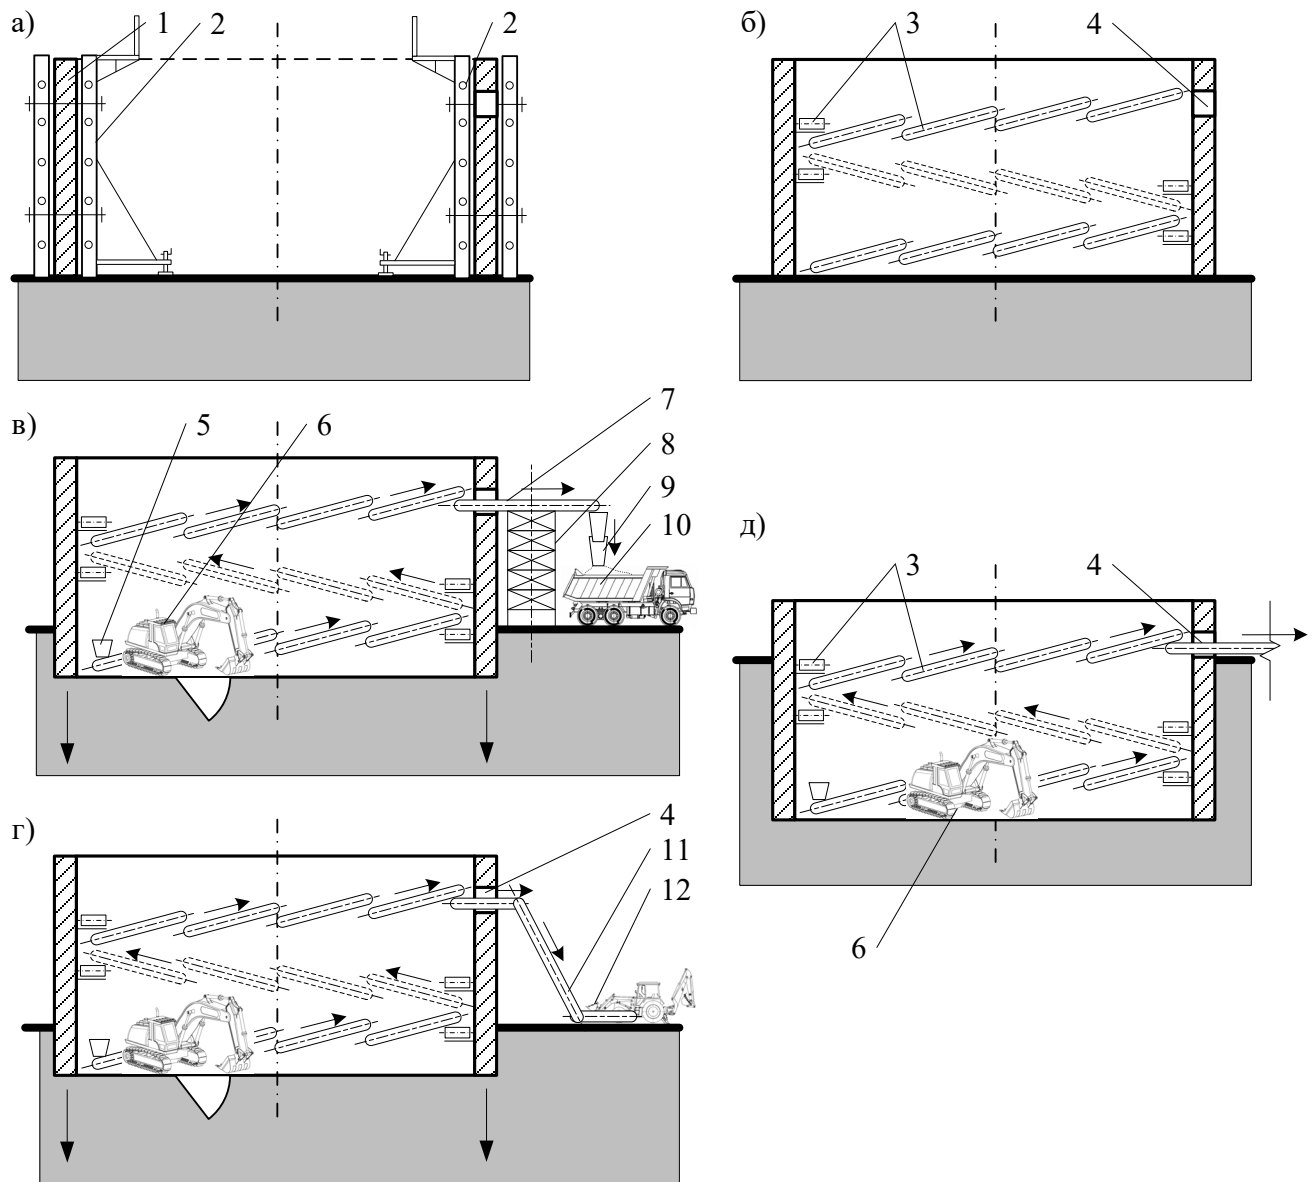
Технологическая схема погружения опускного колодца (поперечные разрезы): а – бетонирование ножевой части, конструкция которой условно не показана, и стен первого яруса колодца; б – монтаж наклонных конвейеров на стенах колодца; в, г – соответственно погружение колодца при разработке грунта на забое экскаватором с транспортированием за пределы колодца по горизонтальному или по сегментному конвейеру (типа Кобра); д – погружение колодца на глубину первого яруса, подготовка к бетонированию стен второго яруса, герметизация технологического окна; 1 – стены колодца; 2 – опалубка; 3 – наклонные конвейеры, монтируемые на внутренних поверхностях стен колодца; 4 – сквозной технологический прямоугольный проем для удаления грунта; 5 – приемный желоб для подачи грунта; 6 – экскаватор (автопогрузчик) на забое; 7 – горизонтальный конвейер; 8 – опускаемая удерживающая конструкция; 9 – желоб для подачи грунта в автотранспорт (10); 11 – сегментный конвейеру (типа Кобра); 12 – экскаватор [49]
